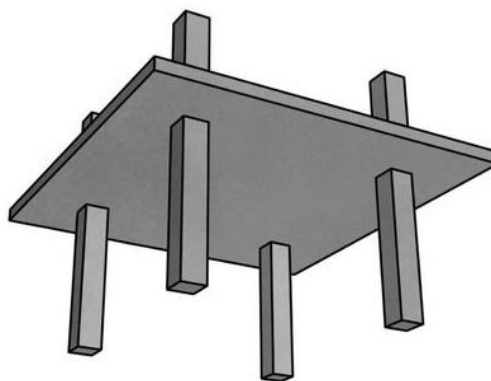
Forjado plano sin vigas. (ACI 314R-16, 2016)
